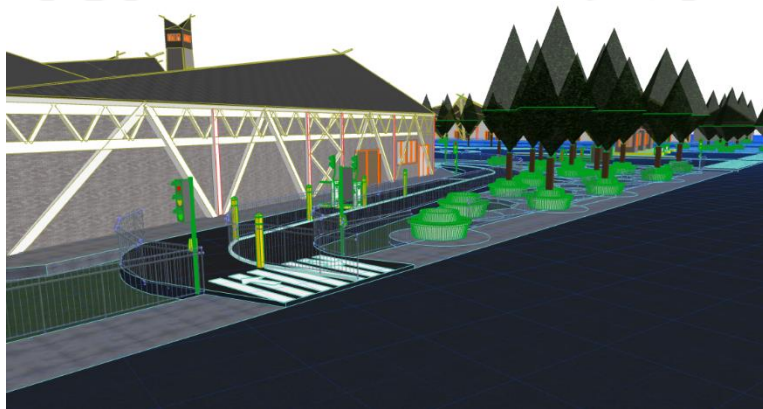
Penampakan gambar rangka baja bentang lebar 1
